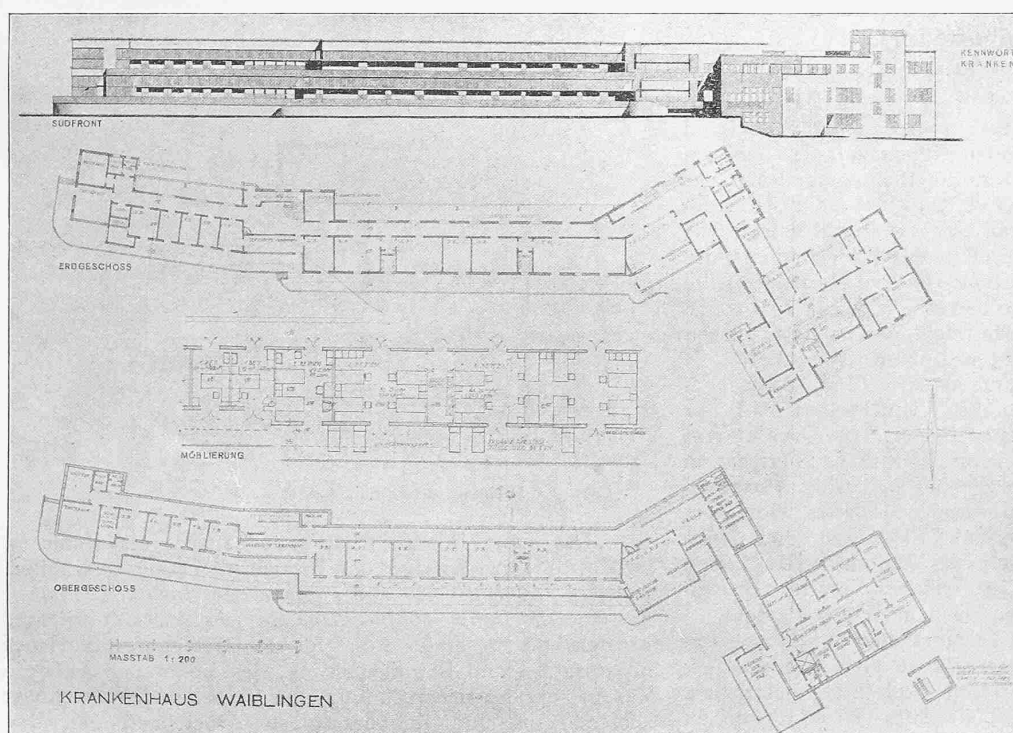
Südfront und Grundrisse des Krankenhauses Waiblingen. — Masstab 1:1000, „Möblierung“ 1:500.
